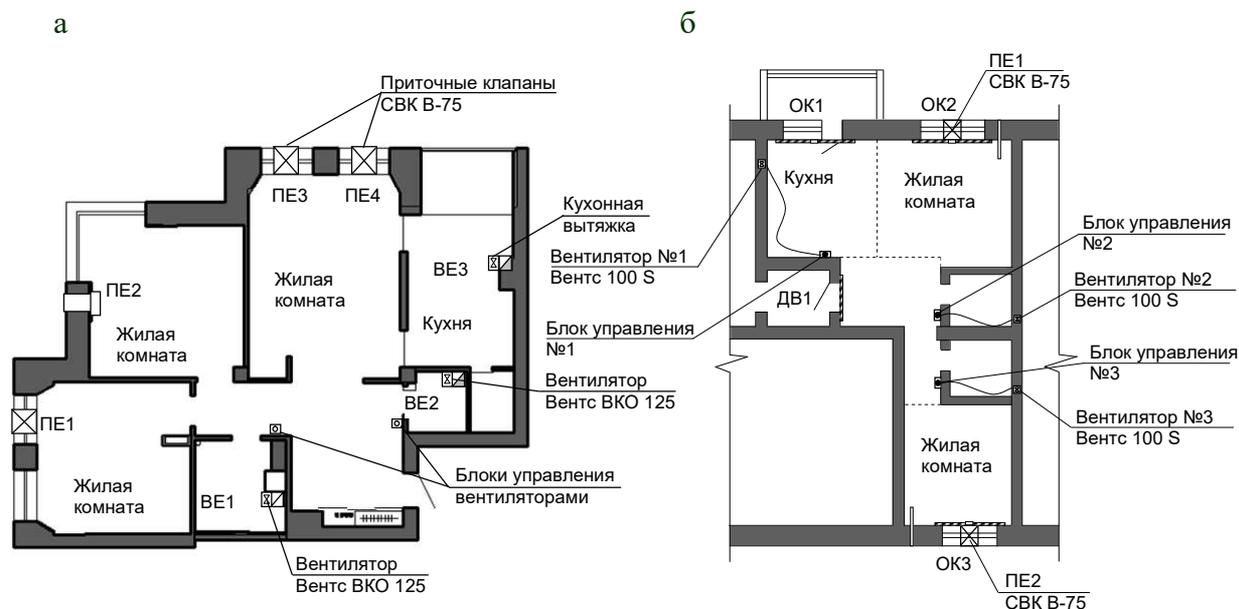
Схематичные планы трехкомнатной (а) и двухкомнатной (б) квартир, в которых проведены натурные испытания систем вентиляции
